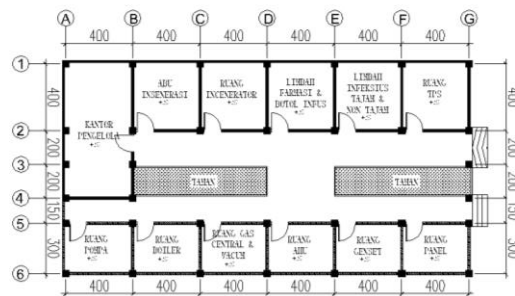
Denah Lantai 2 Bangunan Utama
